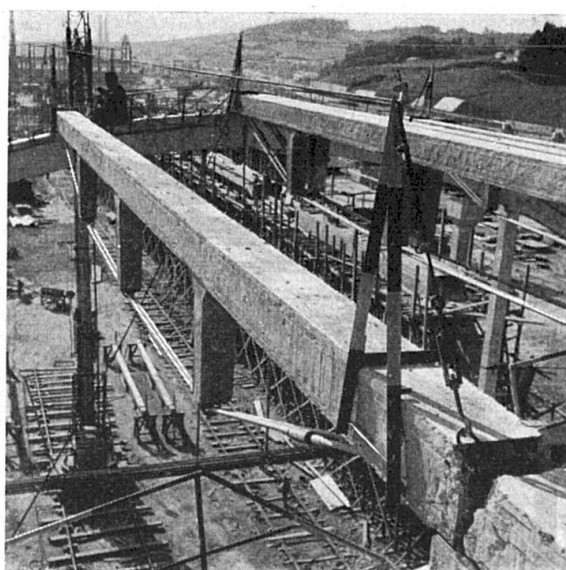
Assemblage des poutres longitudinales sur des arcs.
